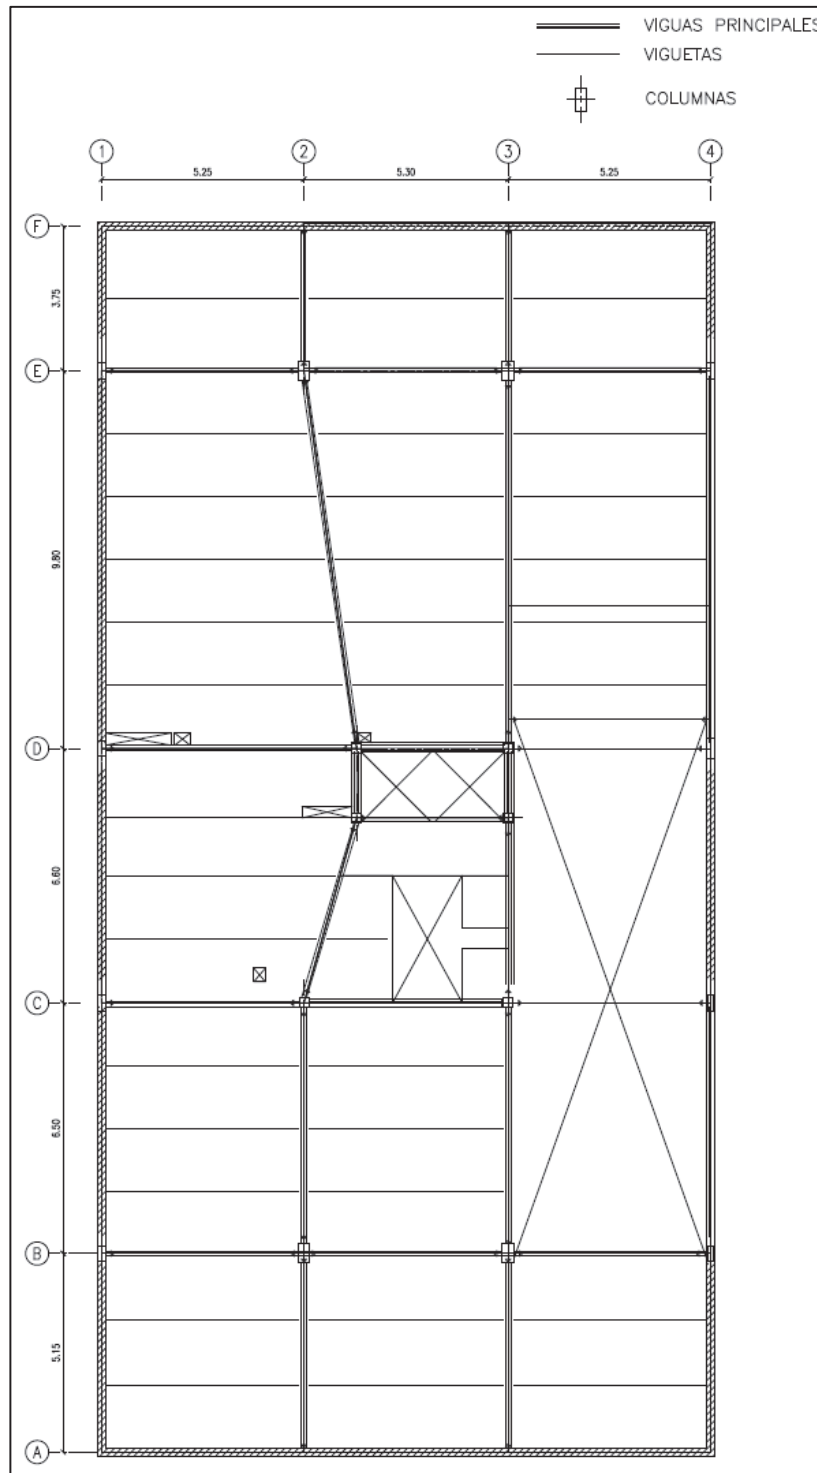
PLANTA ARQUITECTÓNICA EDIFICIO PLUS 1
